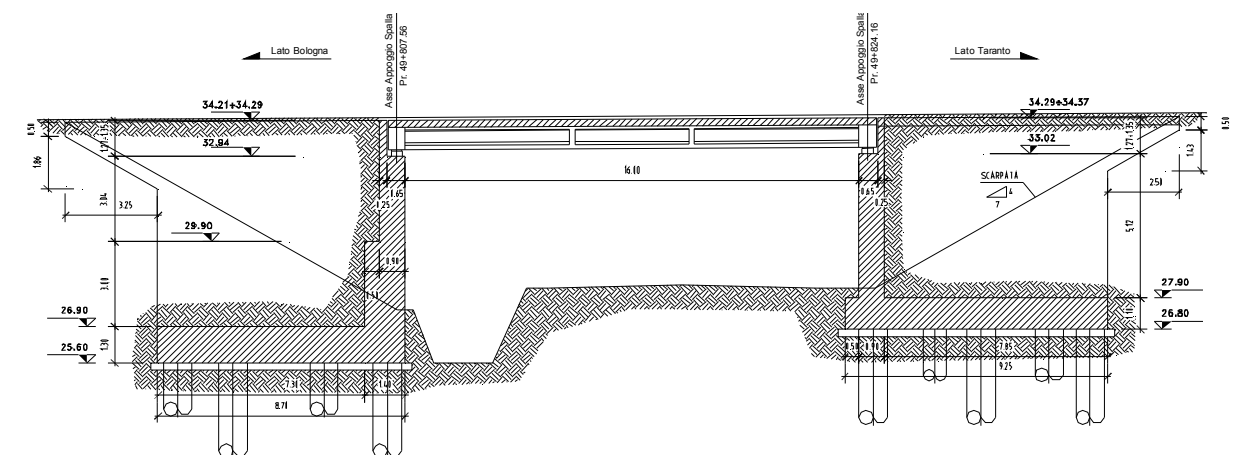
Ponte sul Torrente Selice – Sezione longitudinale su struttura ampliata
